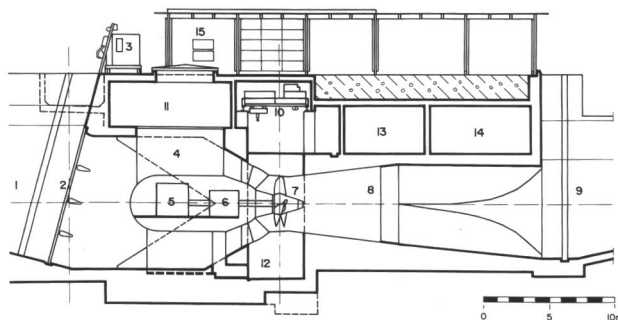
Längsschnitt durch eine Maschinengruppe. 1 Einlauf, 2 Rechen, 3 Rechenreinigungsmaschine, 4 Einstiegschacht, 5 Generator, 6 Getriebe, 7 Turbinen-Laufrad, 8 Saugrohr, 9 Auslauf, 10 35-t-Kran, 11 Steuerraum, 12 Turbinengang, 13 Blocktransformator, 14 Ventilationsraum, 15 Aufenthaltsraum, 16 Hilfsbetriebe, 17 Treppenhaus, Warenaufzug.
